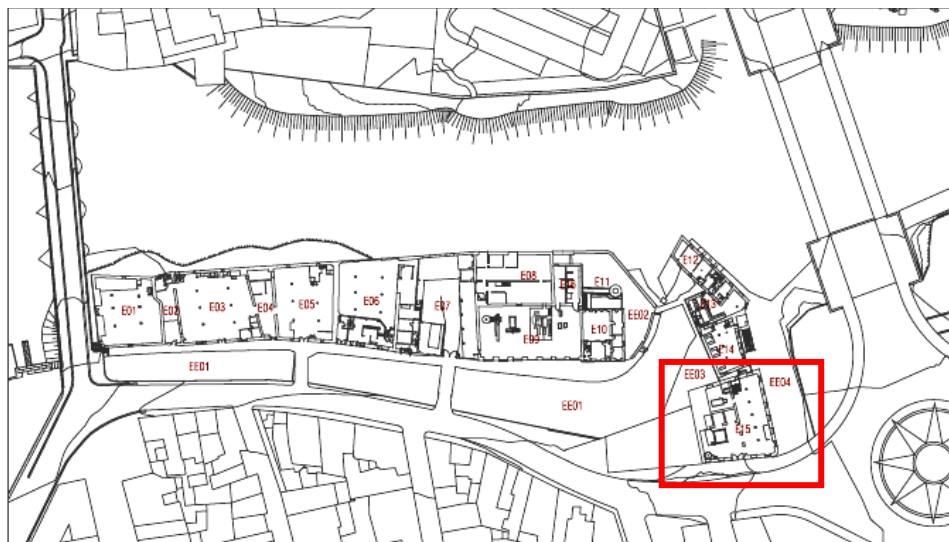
Planta do conjunto edificado da Levada de Tomar com a localização da Moagem *A Portuguesa*¹¹⁸
